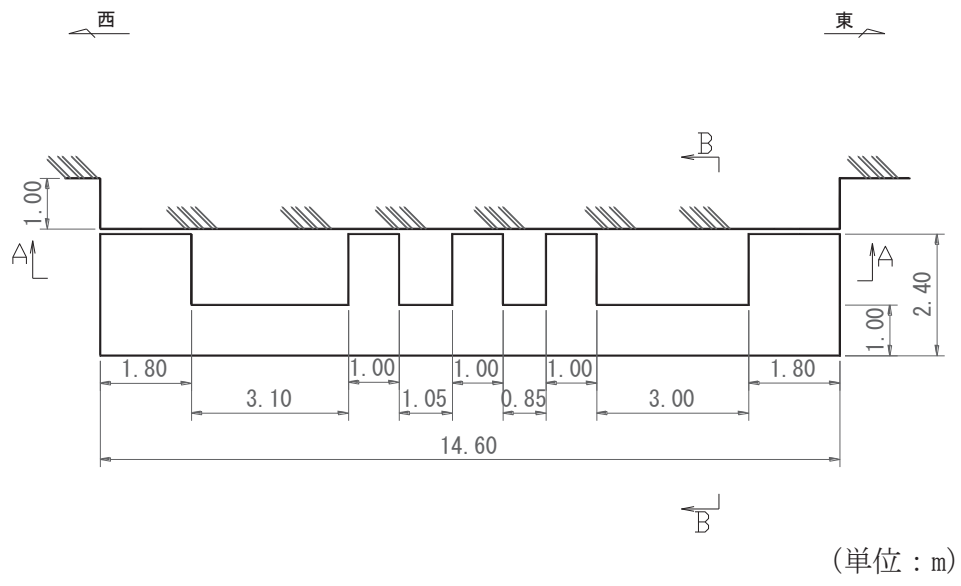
第 3 号機補機冷却海水系放水ピット平面図 (C-C 断面)
